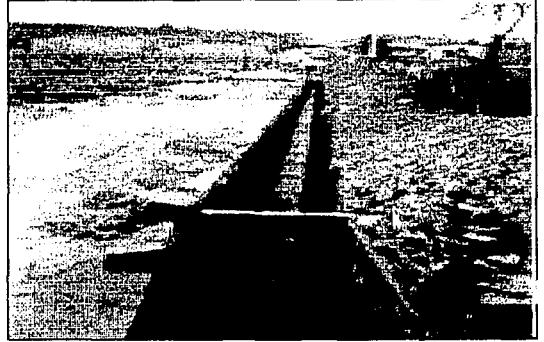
Se aprecia una línea de tubería de drenaje inmersa en el pavimento.
